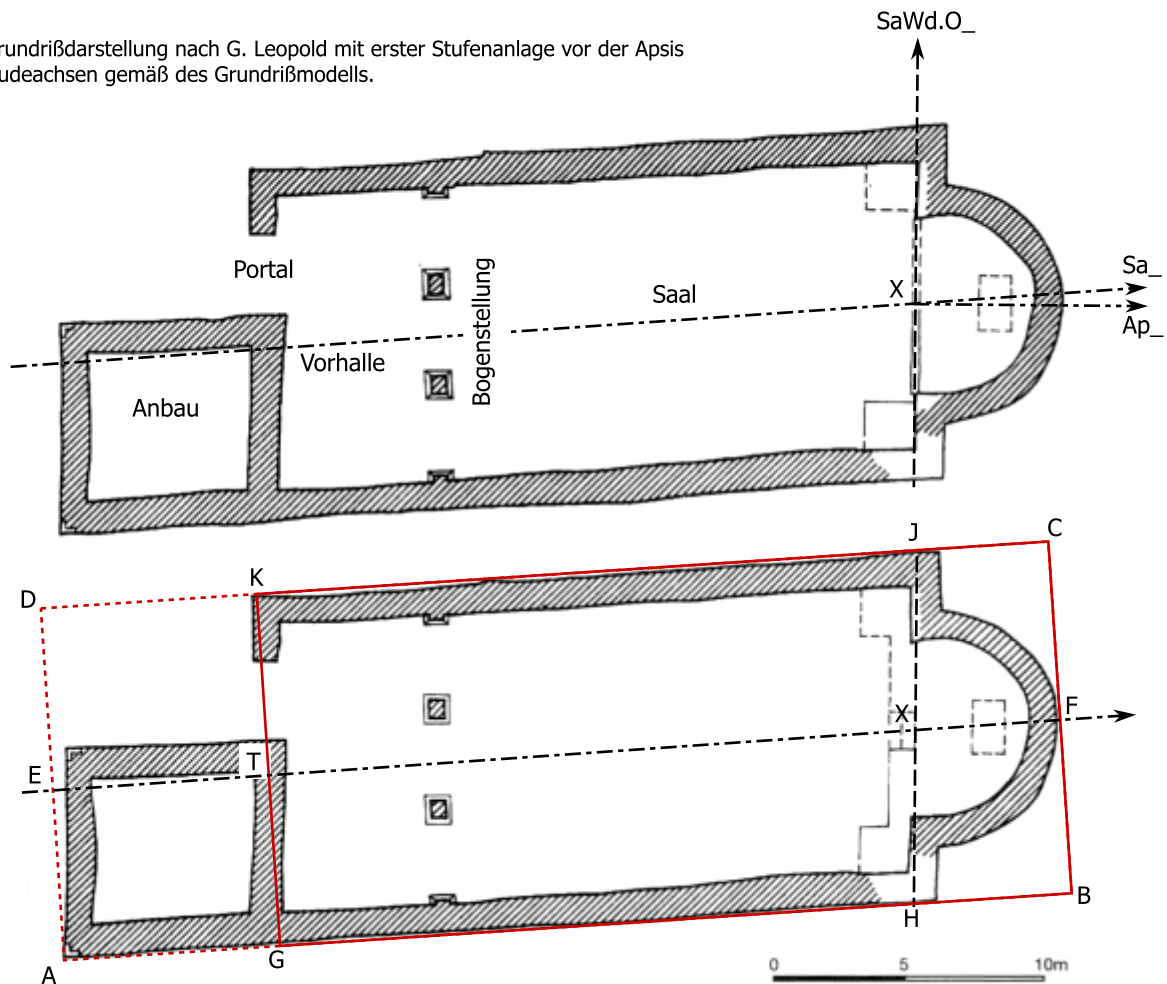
Grundrißdarstellung nach G. Leopold mit zweiter Stufenanlage vor der Apsis sowie Grundrechtecken und Teilungspunkten des Grundrißmodells.
